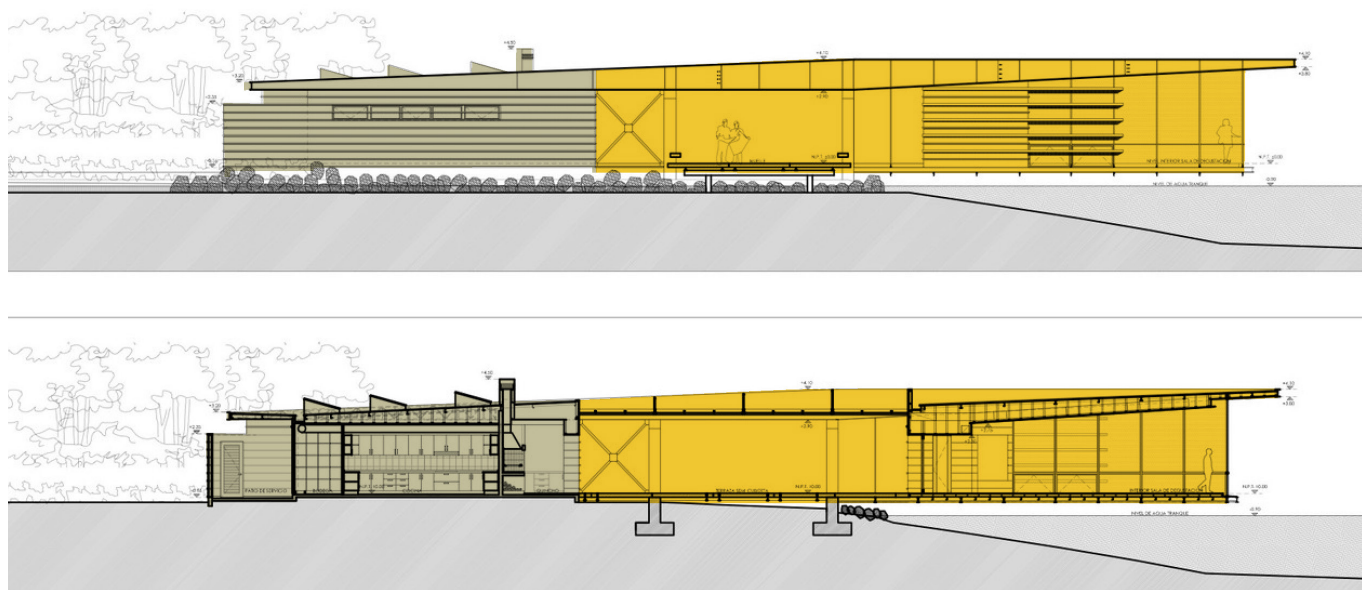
Fachada e corte longitudinal, respectivamente.
